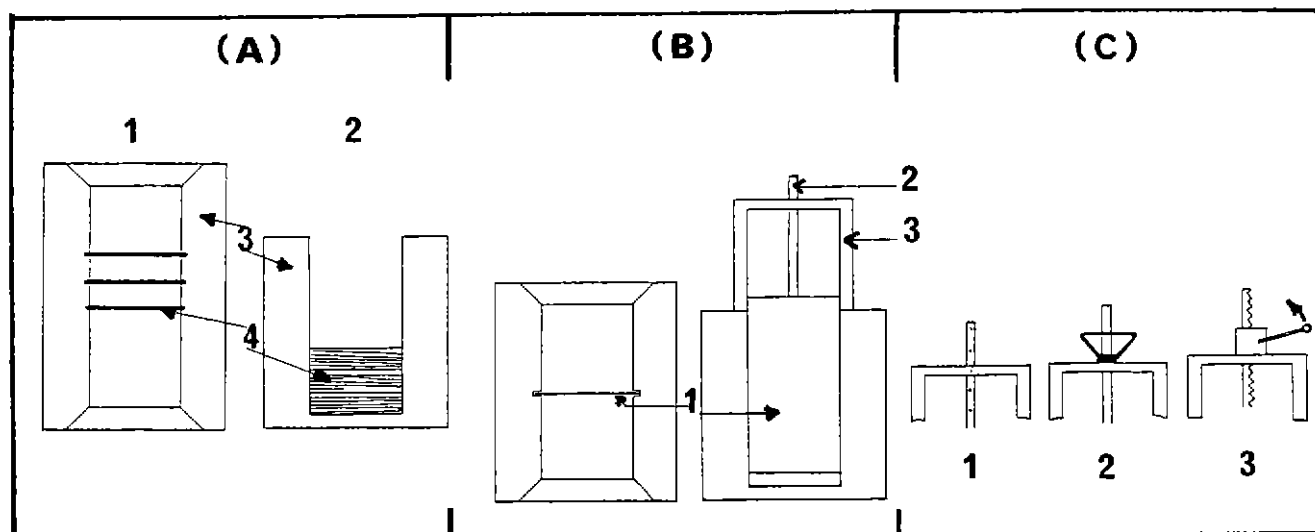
Ouvrages en maçonnerie (*Masonry works - Obras de fábrica*).
